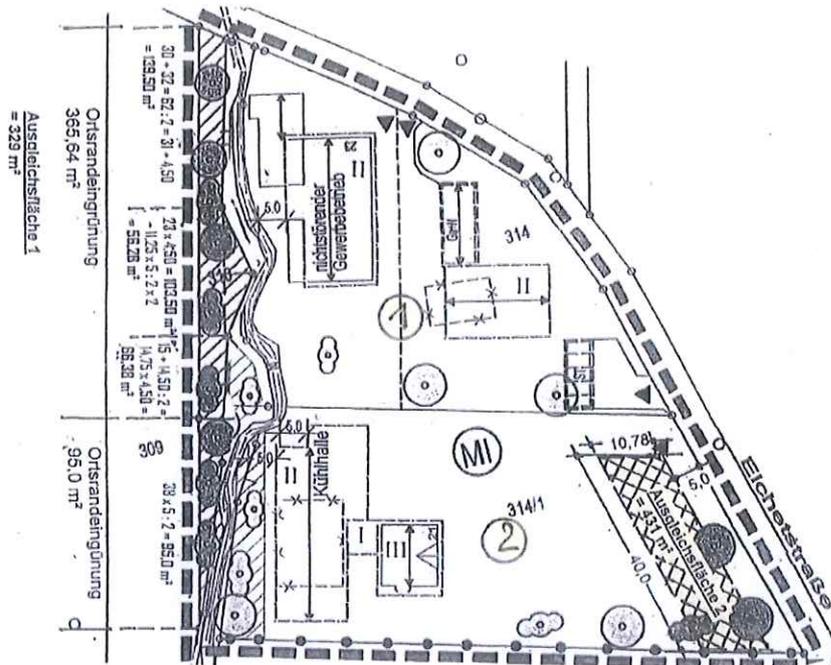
Ausgleichsflächen rechtskräftiger Bebauungsplan
